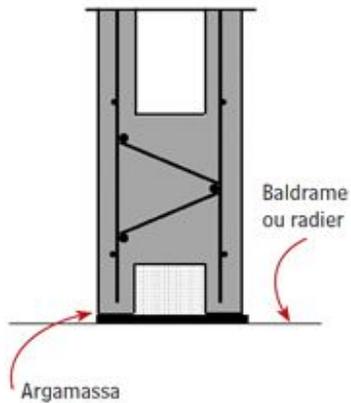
Esquema geral da interface painel e fundação – Painel apoiado diretamente sobre o elemento de fundação
